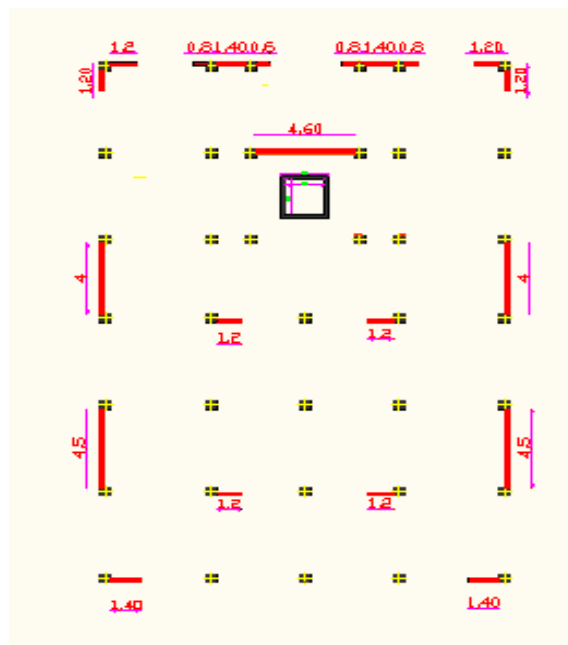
la troisième disposition des murs voiles et poteaux .
